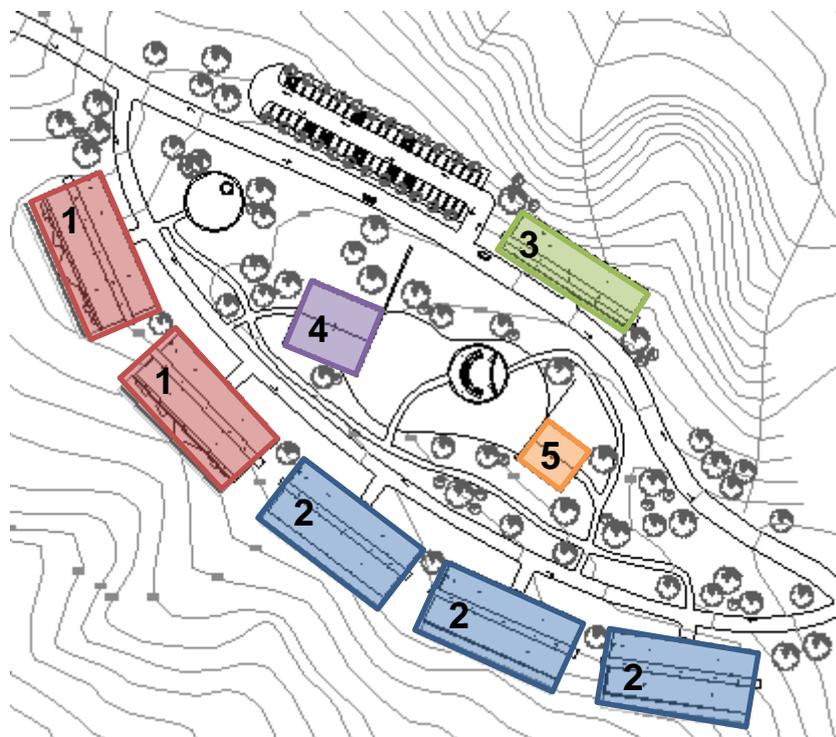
Planta de Implantação, dividida por Núcleos.
